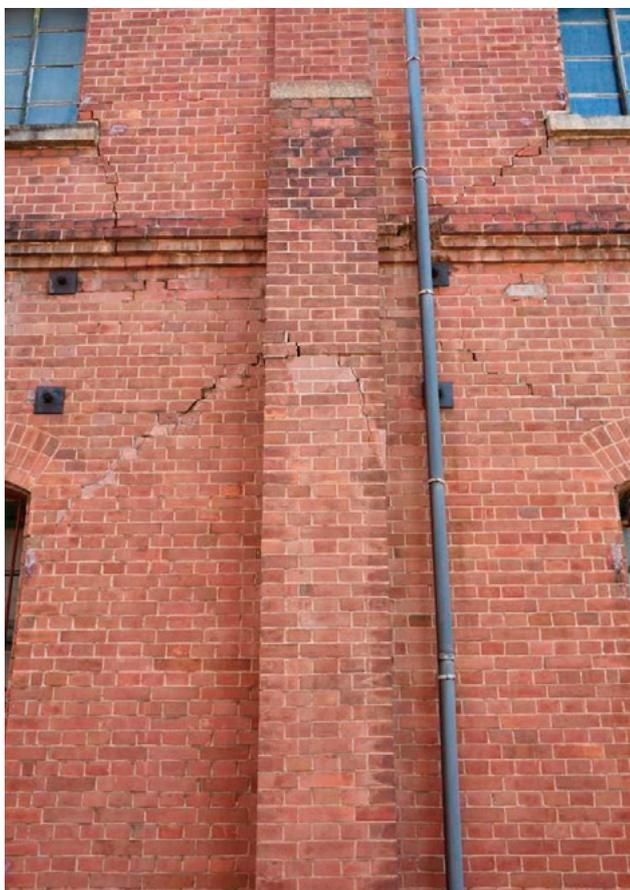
第八庫東北側の外壁及びバットレスのひび割れ
